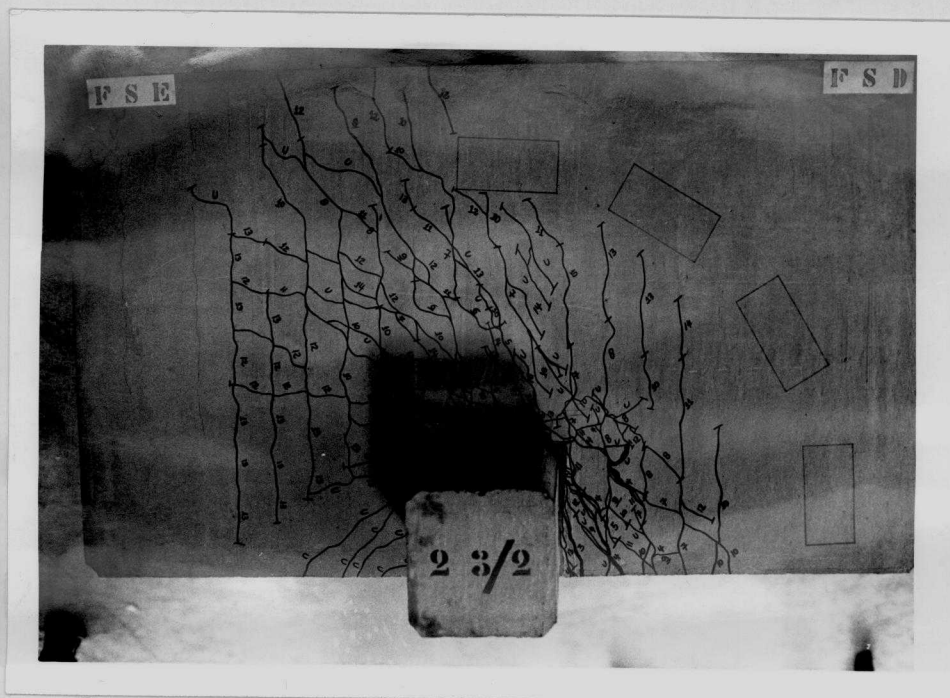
a - Fissuração na face superior do modelo EdL 23/2.
